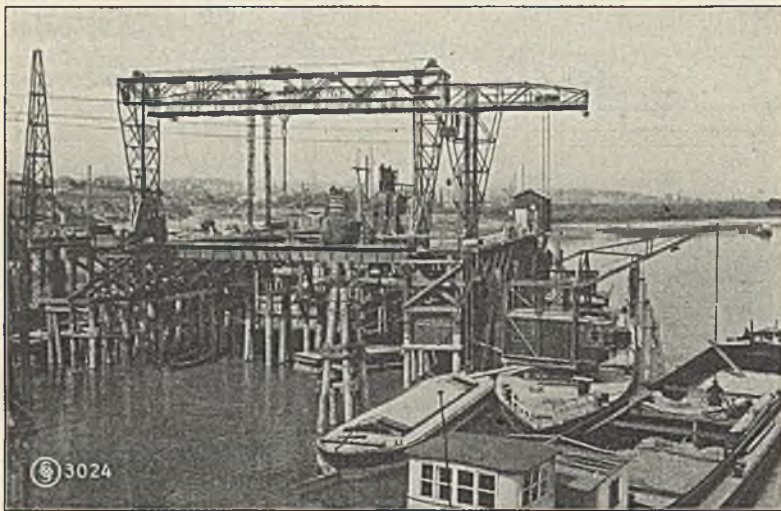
Pfeilerbaustelle I von Unterstrom mit Betonmischanlage.
